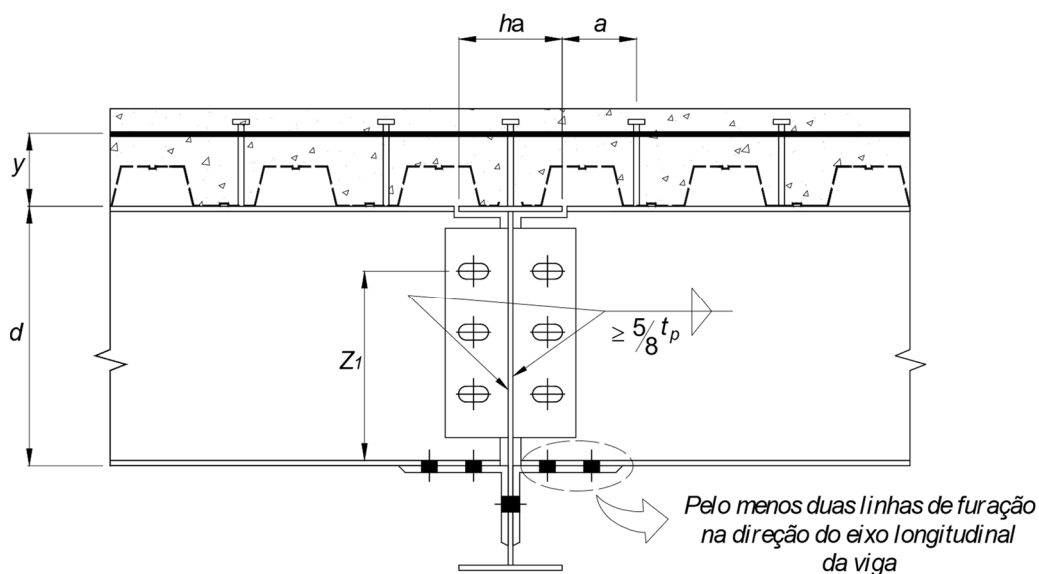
Ligação mista com chapa simples parafusada na alma e cantoneira parafusada na mesa inferior da viga apoiada
